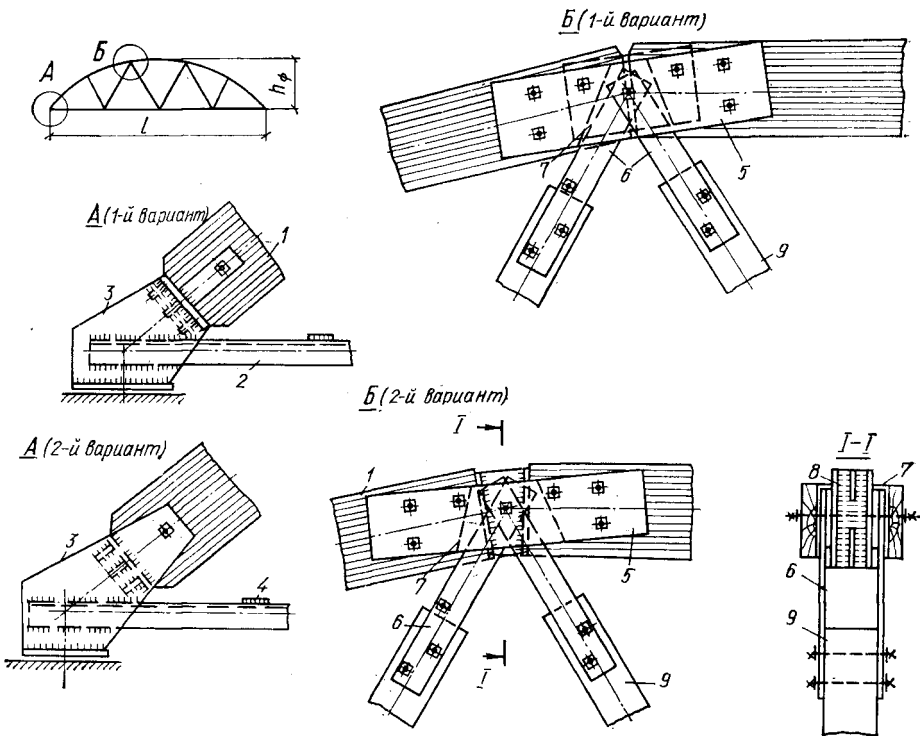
Сегментная металлодеревянная ферма с клееным верхним поясом:
